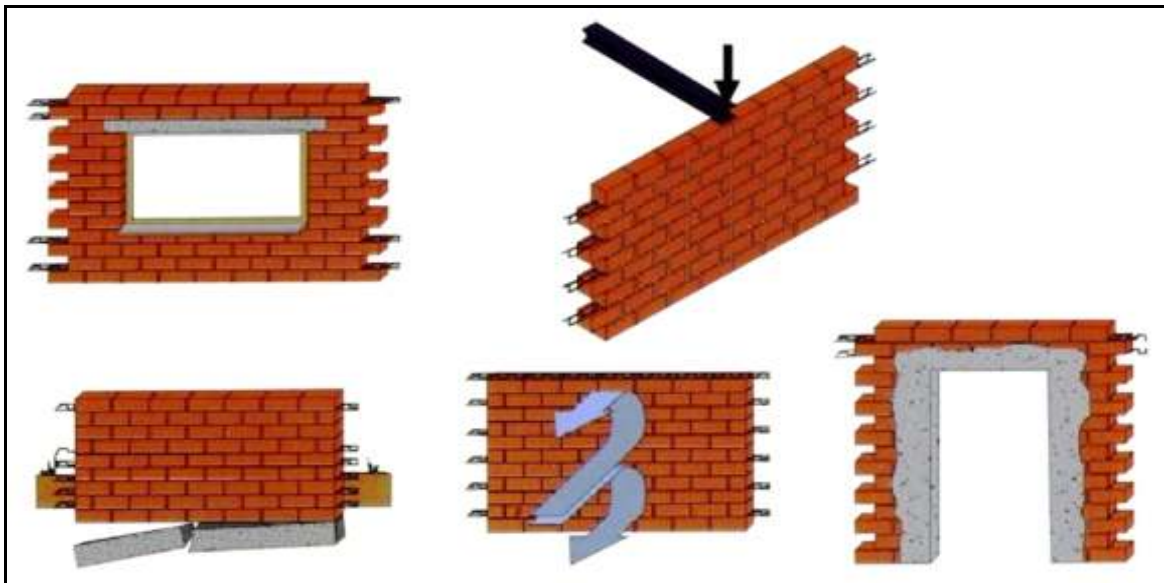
Armaduras em juntas de assentamento de paredes de alvenaria [3].
